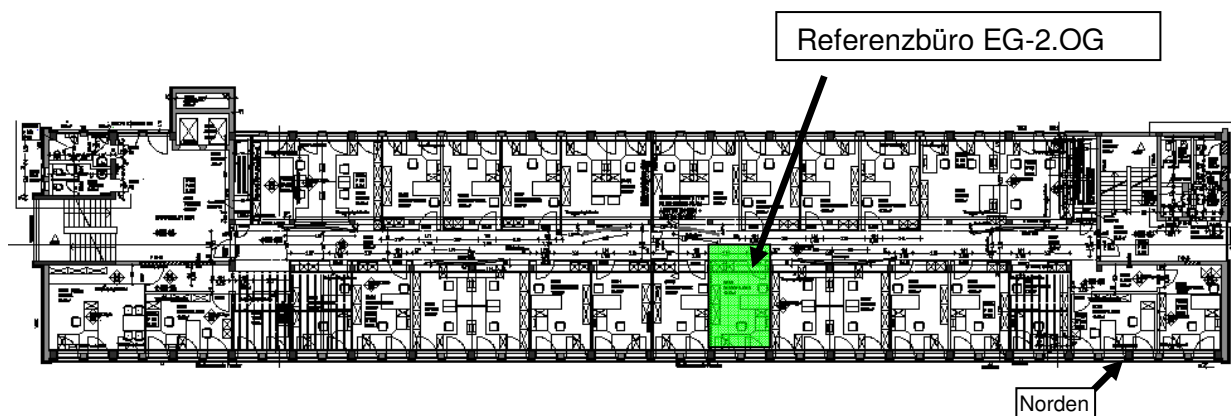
98 Referenzbüro EG-2.OG im Grundriss
